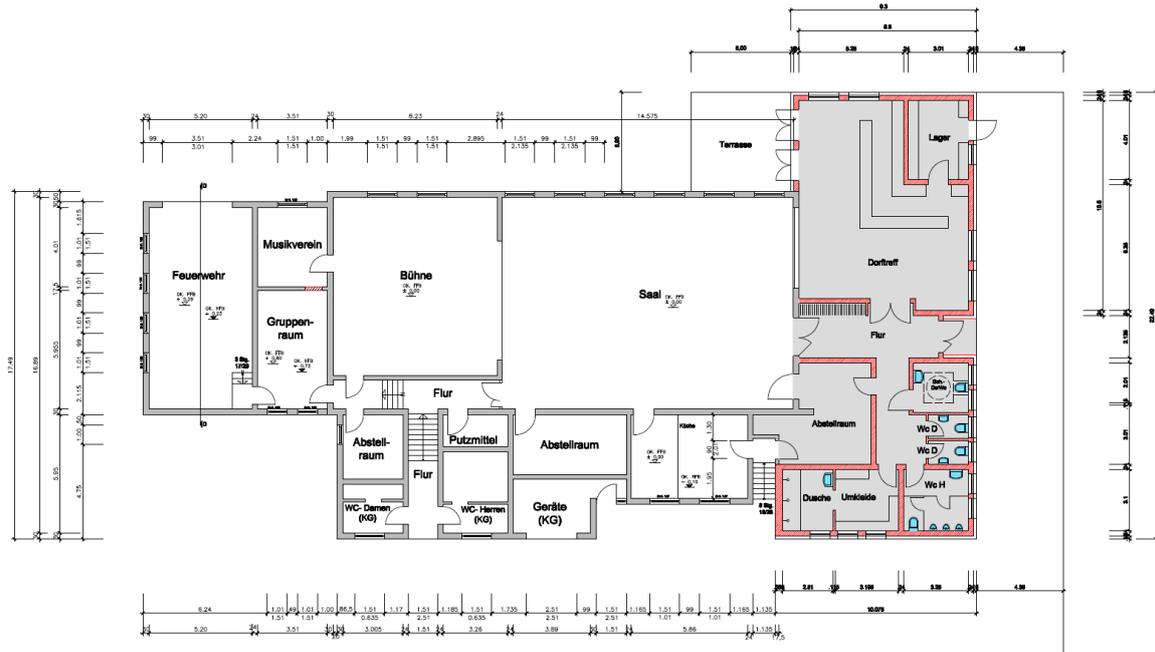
Ansicht des Grundrisses EG Entwurf Bürgerhaus (Entwurf VG Prüm)
